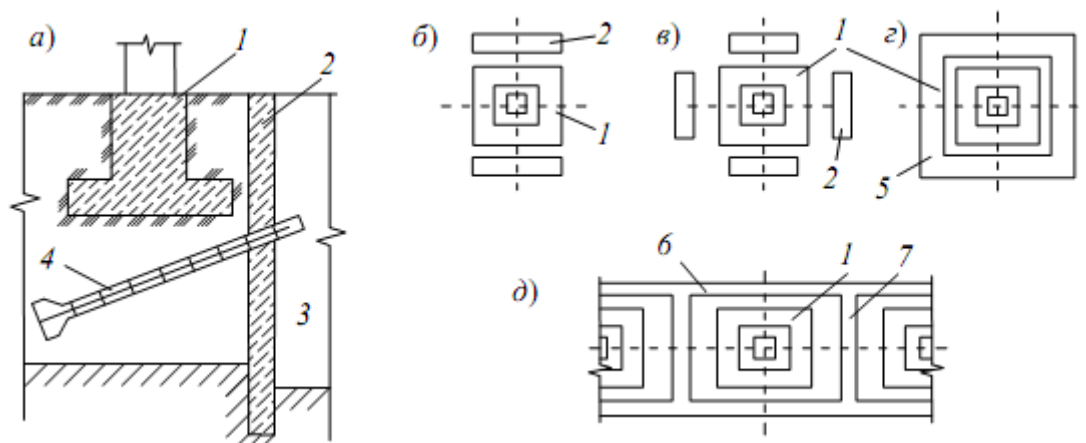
Схеми підсилення фундаментів способом "стіна в ґрунті":
